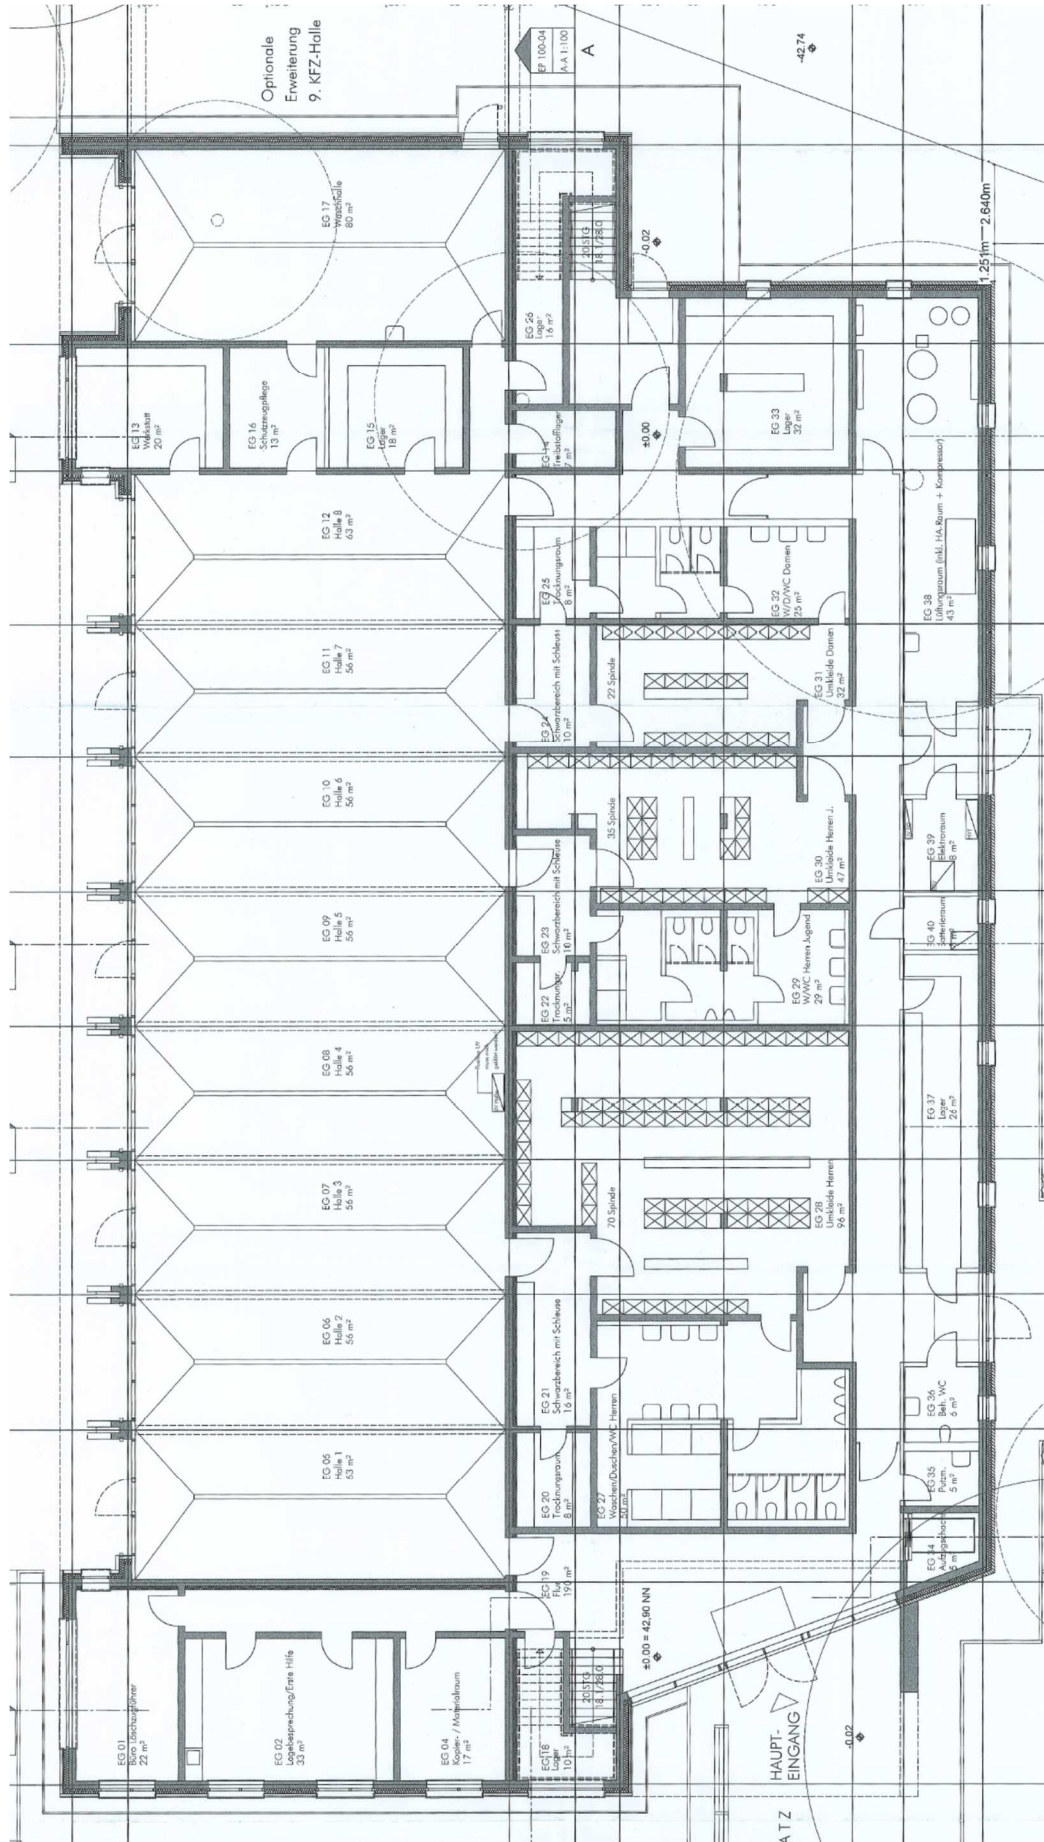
Neubau Feuerwehrhaus Büttgen Grundriss Edgeschoss
